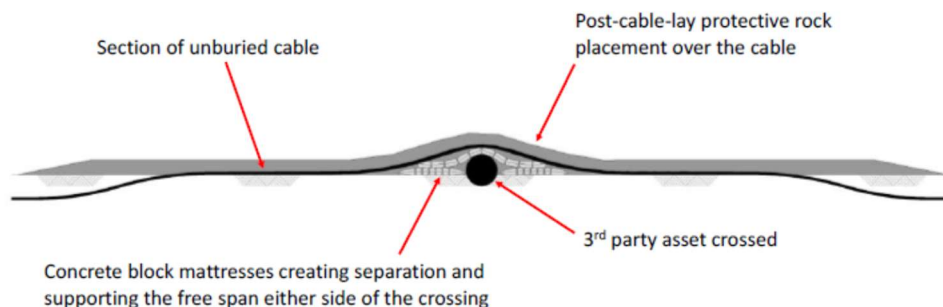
Primjer polaganja kabela iznad elementa treće strane [1]
